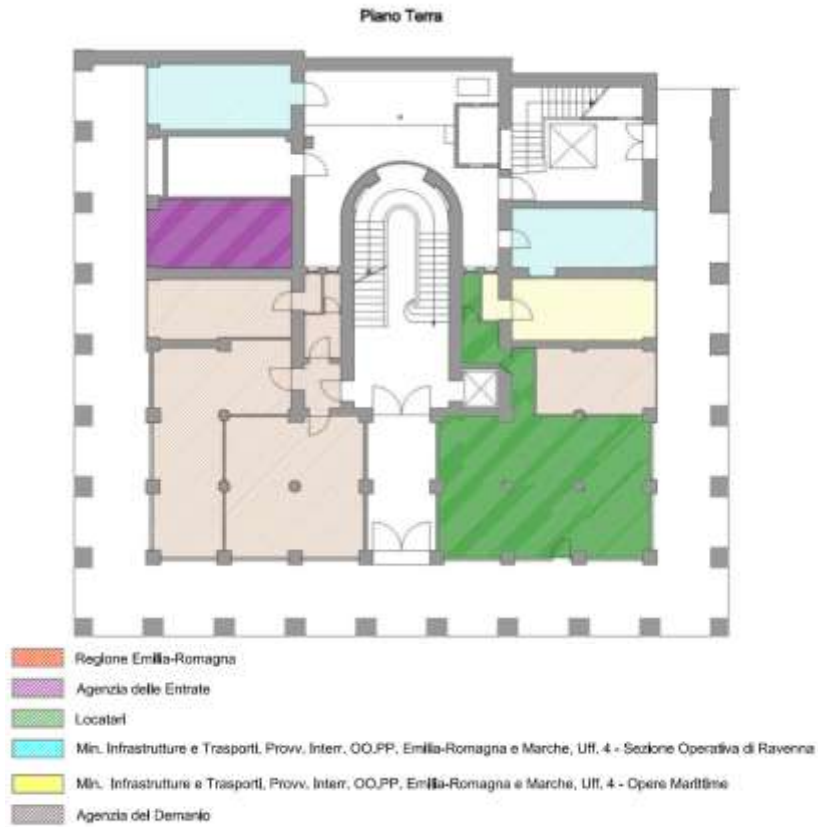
Pianta degli spazi occupati: piano terra.
